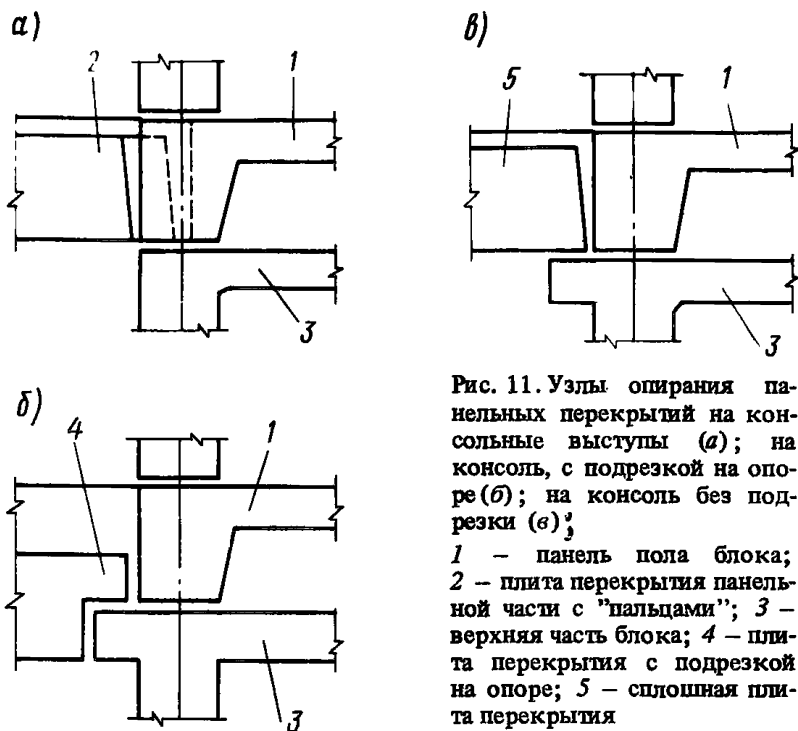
Узлы опирания панельных перекрытий на консольные выступы (а); на консоль, с подрезкой на опоре (б); на консоль без подрезки (в);
